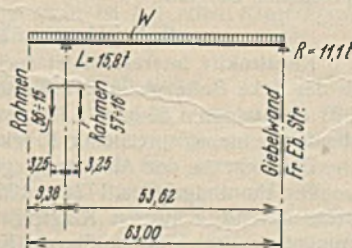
Windbelastungsschema der Decken in den normalen Geschossen.
